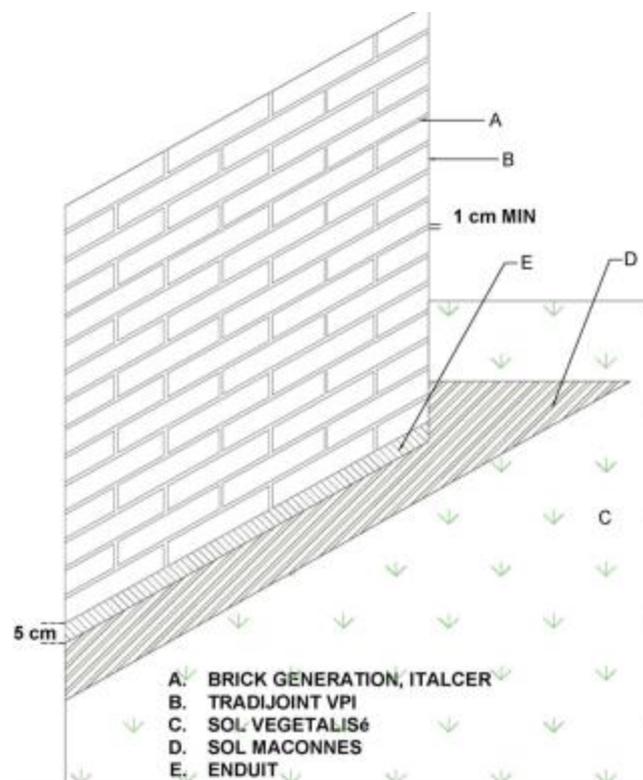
Traitement raccord entre Brick génération et enduit de façade (vue latérale)
